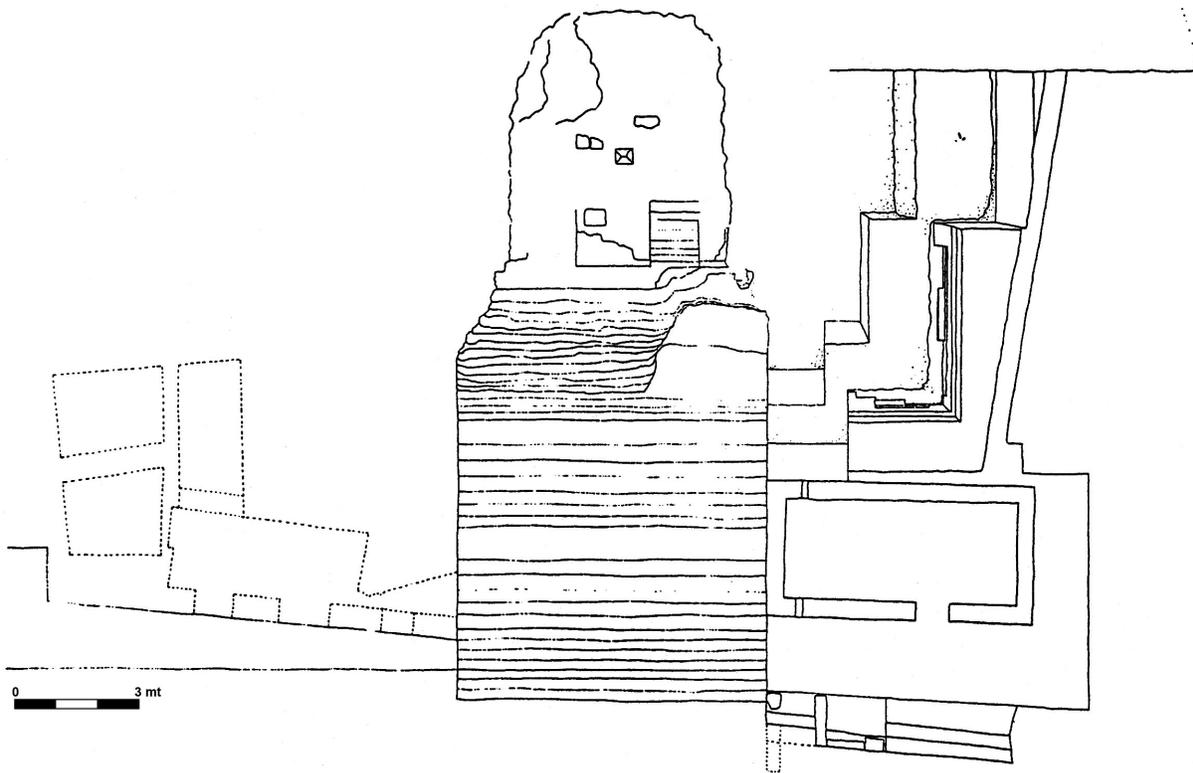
Planta de la Estructura CA-4 de Oxkintok
